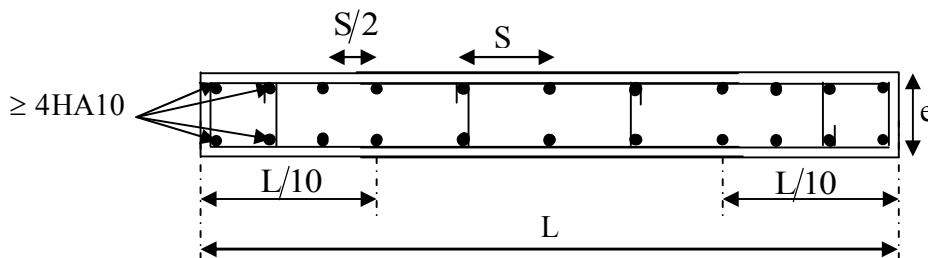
Disposition des armatures verticales dans les voiles
